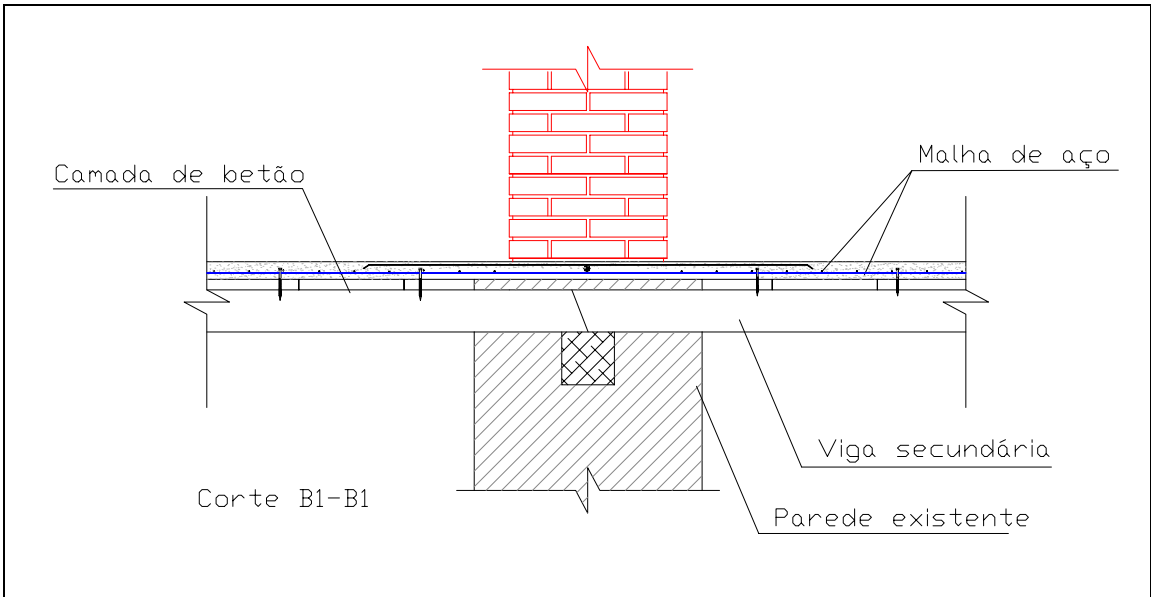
Pormenor da ligação entre pavimentos e paredes de contraventamento.
